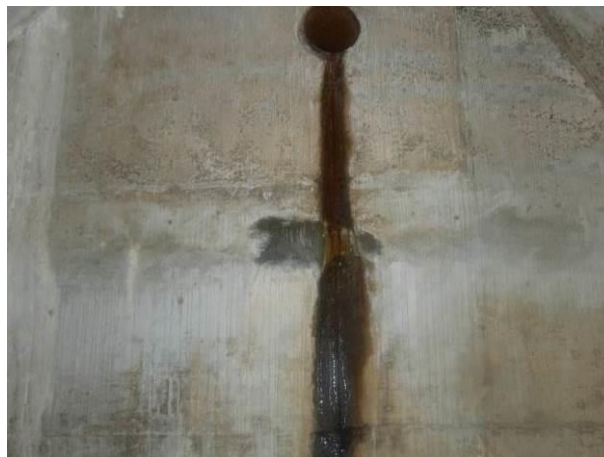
Widok na stan techniczny sekcji nr 16a konstrukcji galerii kontrolno-zastrzykowej
